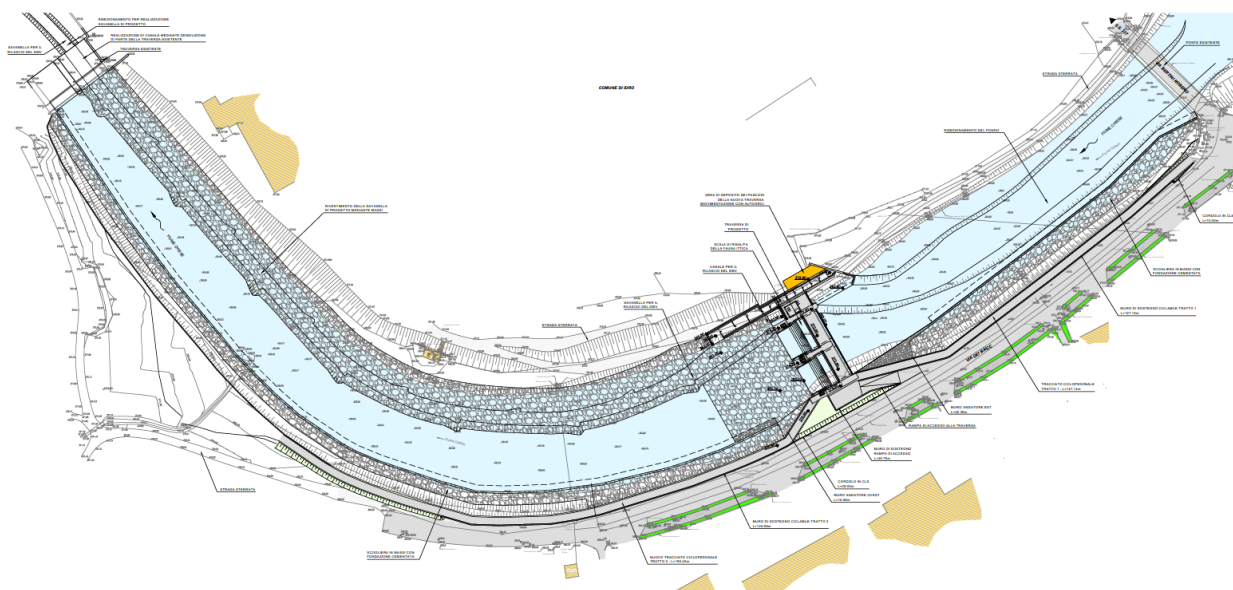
Planimetria nuova traversa e sistemazione alveo Fiume Chiese
